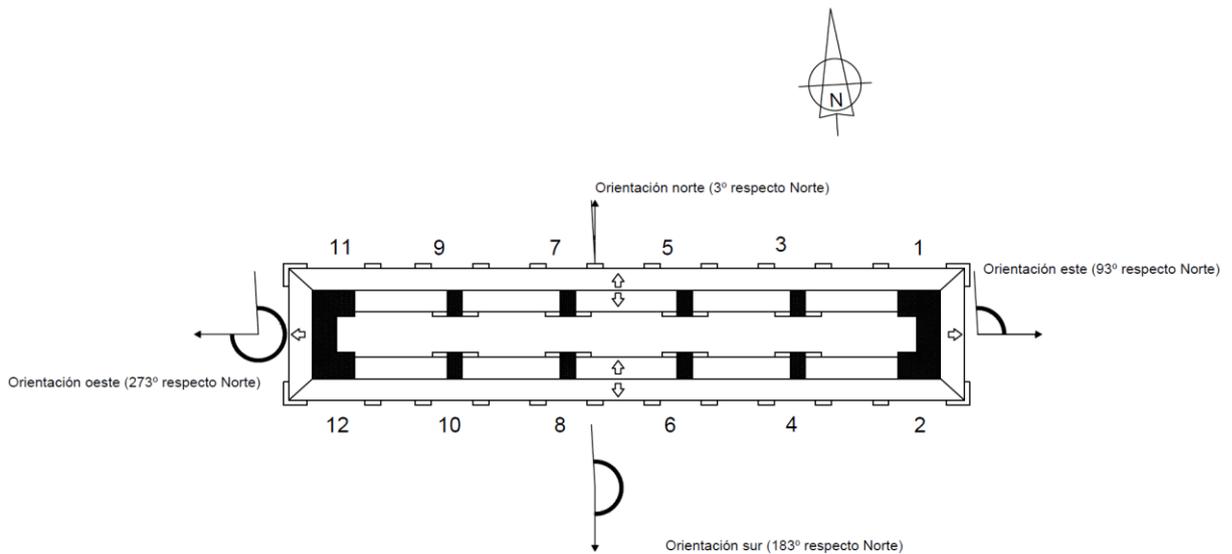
Orientación de las fachadas del bloque de edificios. (Anejo A: Planos)
